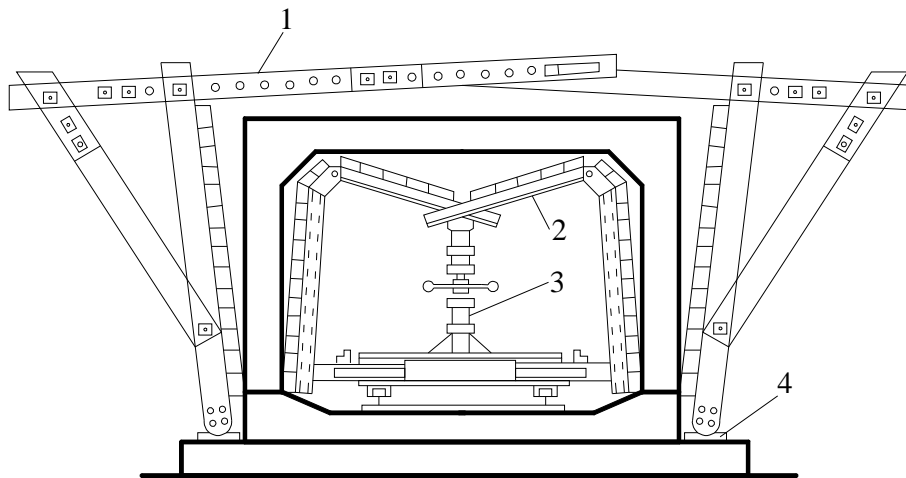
Котюча опалубка для бетонування прохідних каналів:
